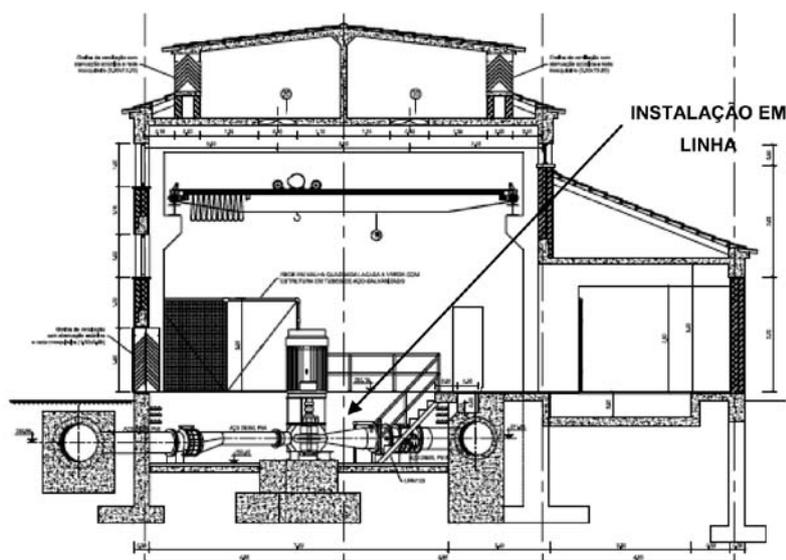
Nave de Bombas de Câmara Seca (Instalação Vertical)
